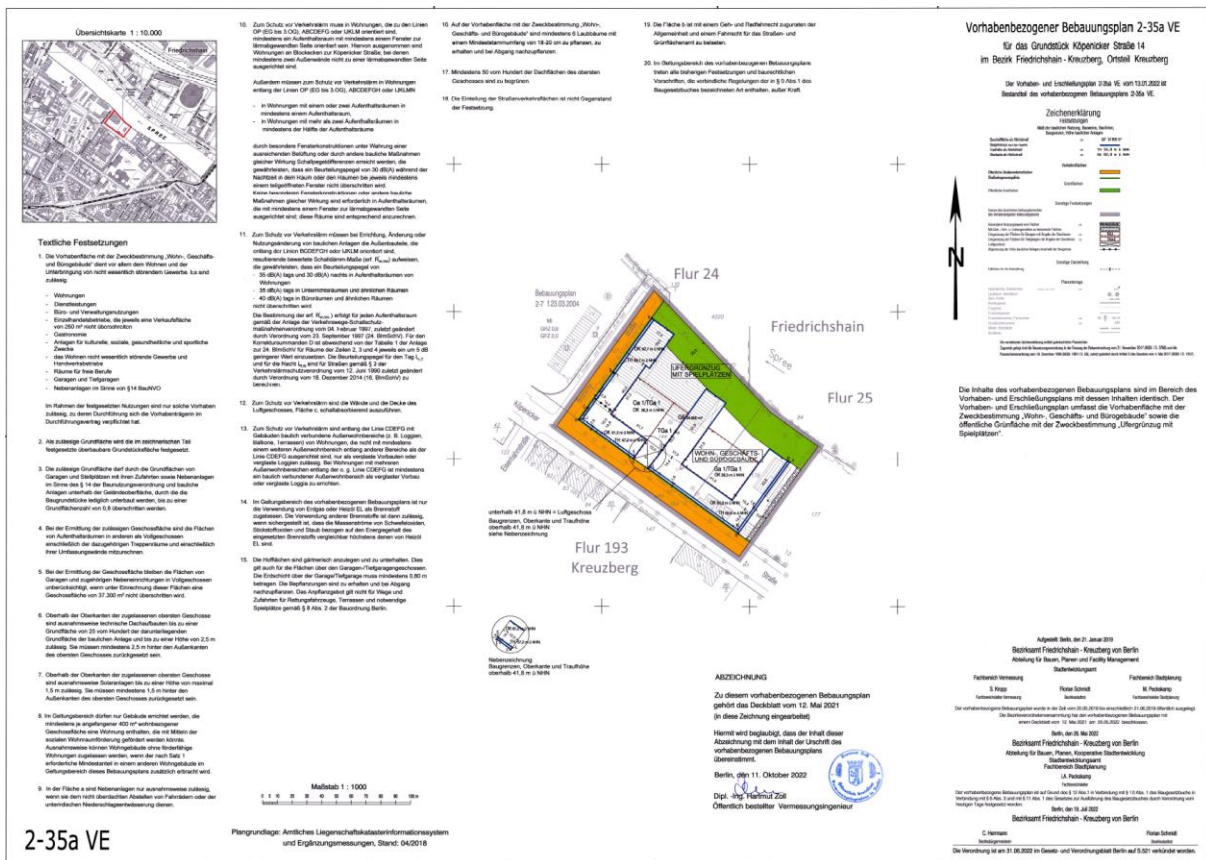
Planzeichnung des Vorhabenbezogenen Bebauungsplans 2-35aVE /26/ In der vorliegenden Untersuchung wurden die Gebäude auf dem Grundstück Köpenicker Straße 14 gemäß der aktuellen Planung für das Vorhaben K 14 /41/ berücksichtigt. Die nachfolgende Abbildung zeigt eine Vogelperspektive des Entwurfs.
